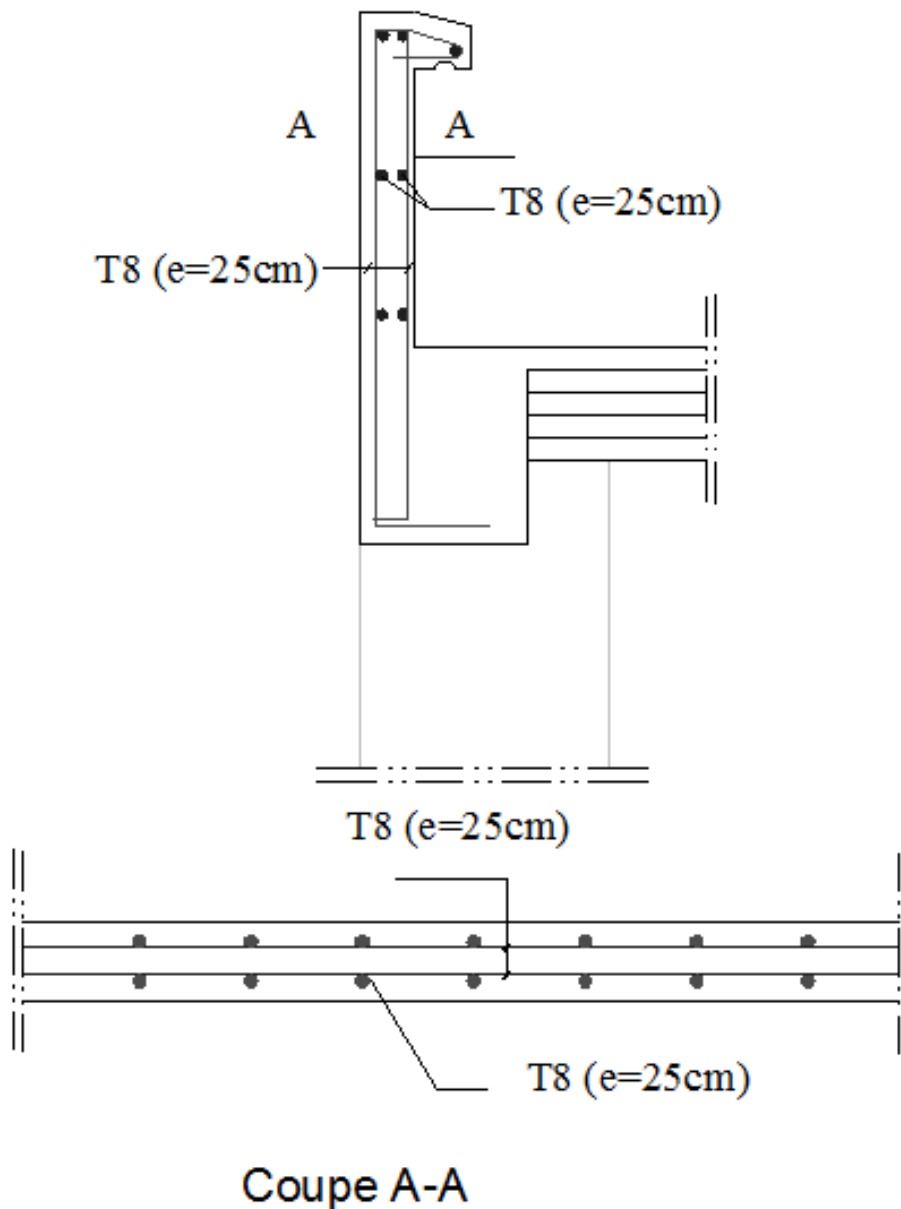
Coffrage et ferrailage de l'acrotère
